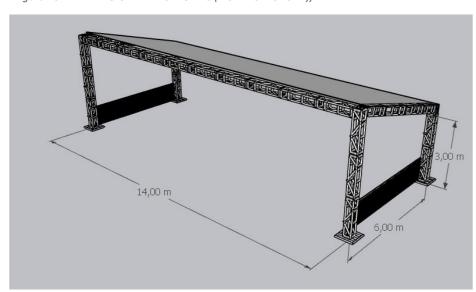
PAVILHÃO UNIDADES MÓVEIS (VISTA ESTRUTURA))
